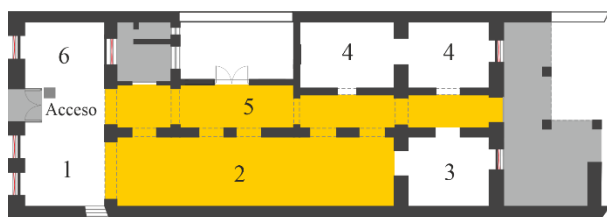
Planta del Museo de Arte Sacro de Tucumán. Fuente: elaboración propia
